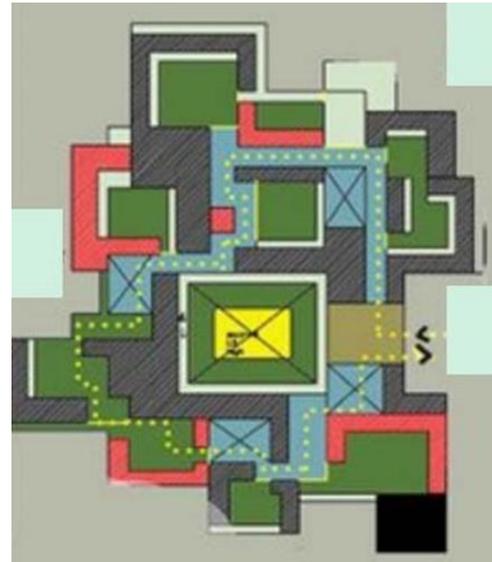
Plan d'assemblage du projet, source : wkiarquitectura.com
